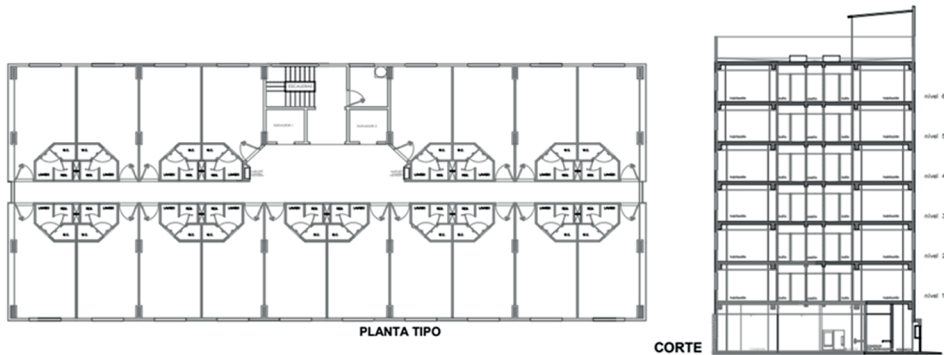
Planta y corte esquemático del hotel 4 estrellas (Fuente: ConstruBASE, s.f.).
